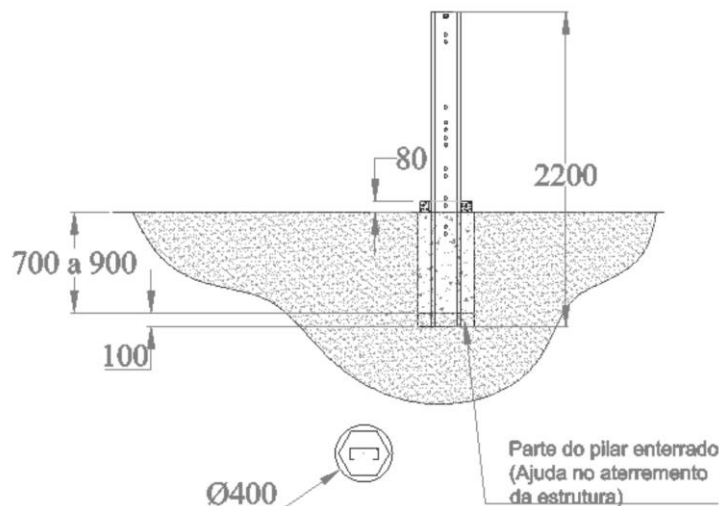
Desenho esquemático da base dos pilares da estrutura
